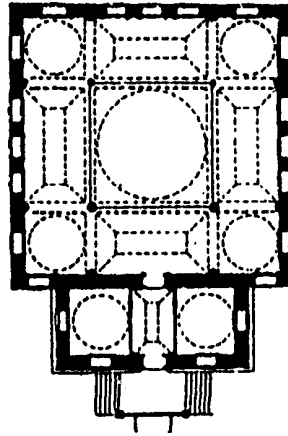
مسقط أفقي لجامع محمد علي القاهرة (عن : Hautecoeu Retwiet)
